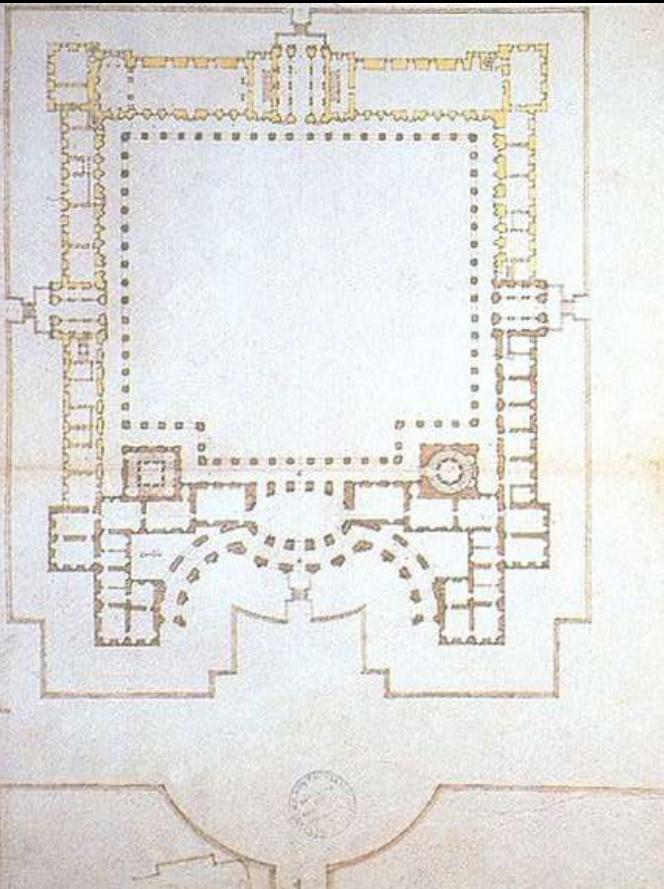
Zweiter Bauabschnitt. Grundriss
